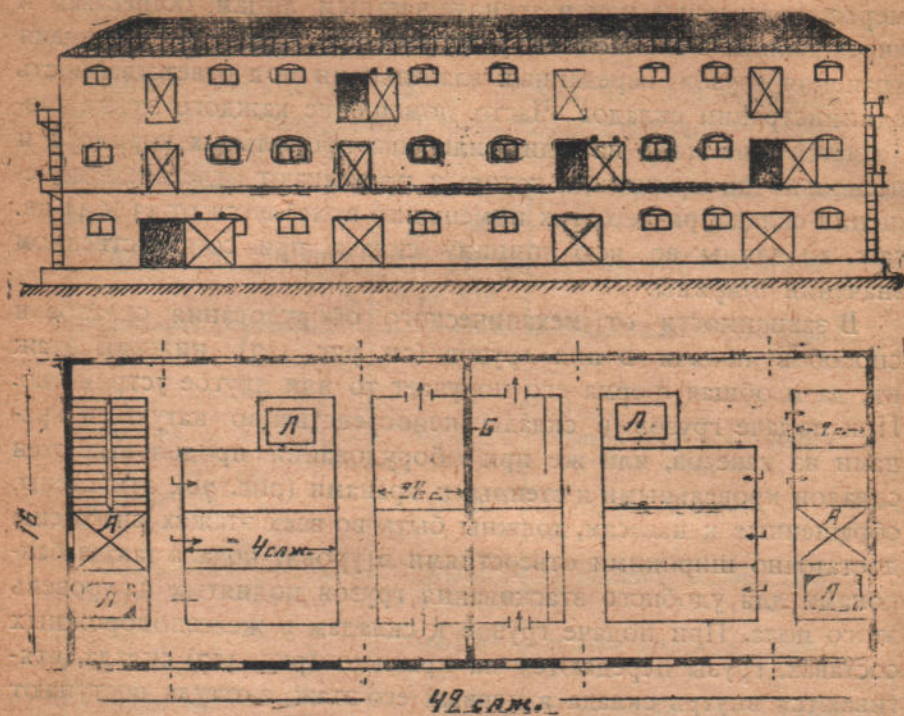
План расположения отдельных помещений портового склада для штучных грузов.
